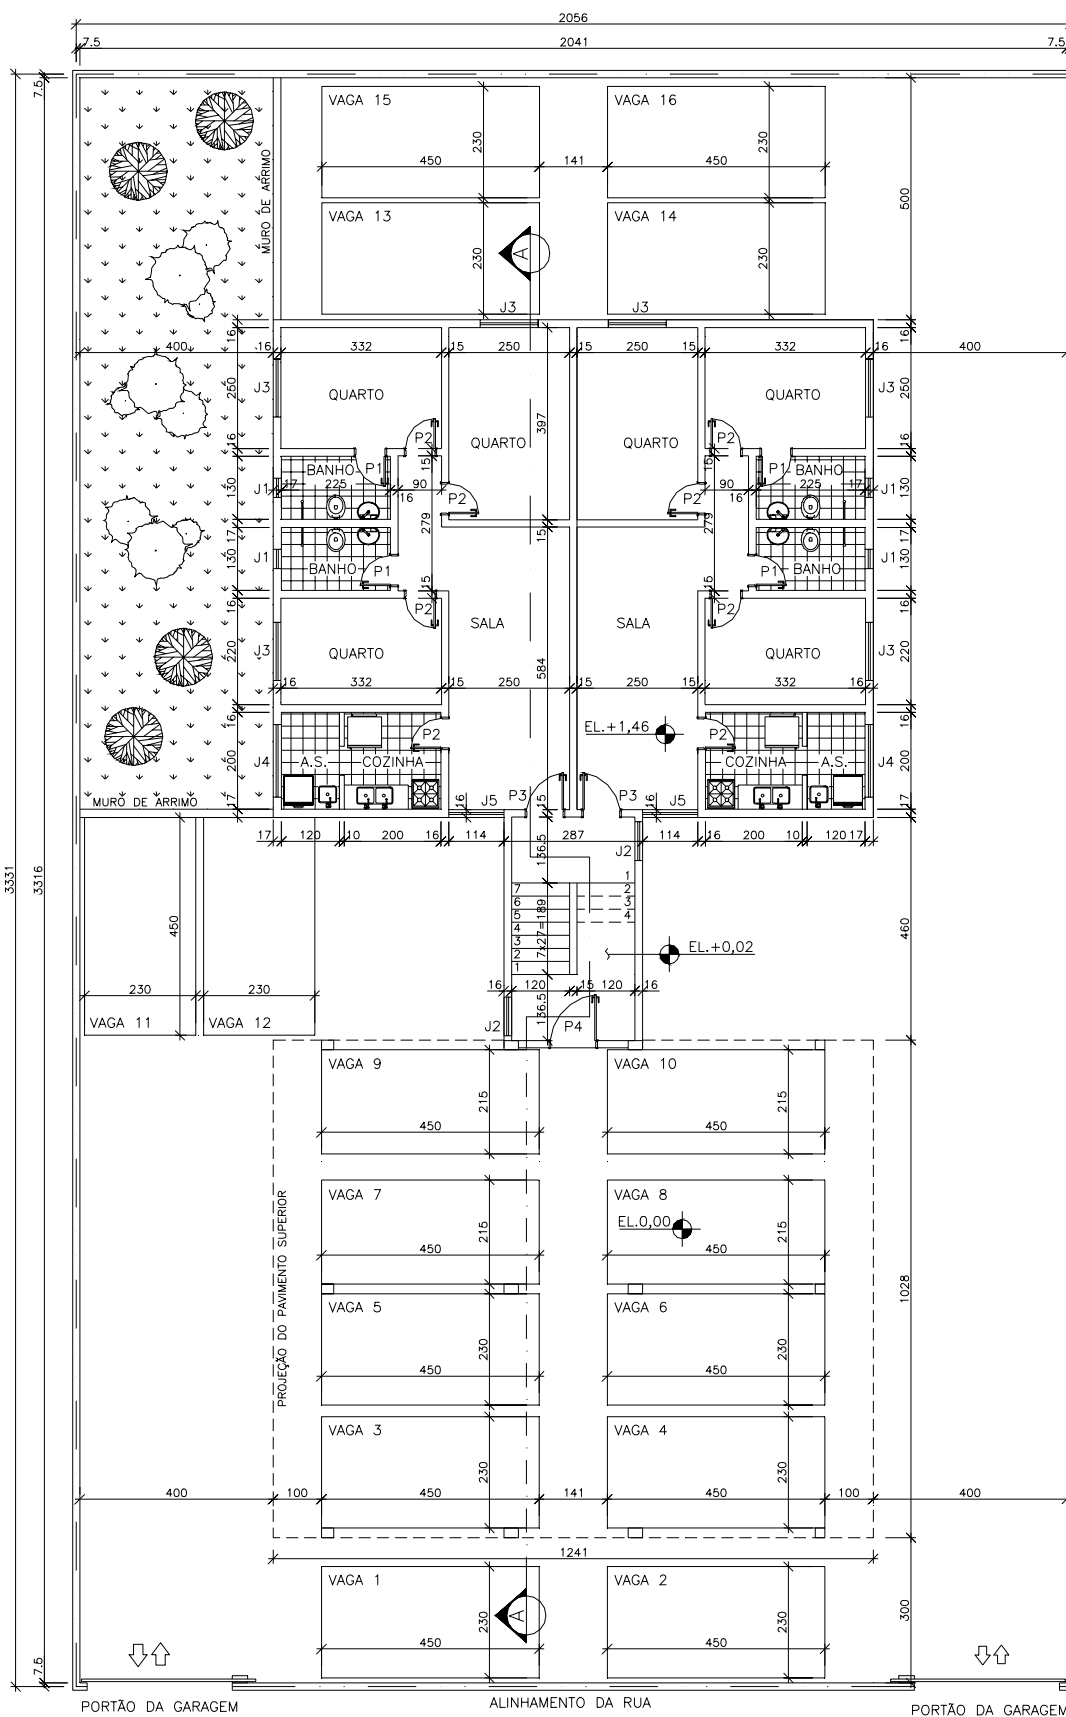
Prédio “C” – Opção 1 – Planta da Garagem
